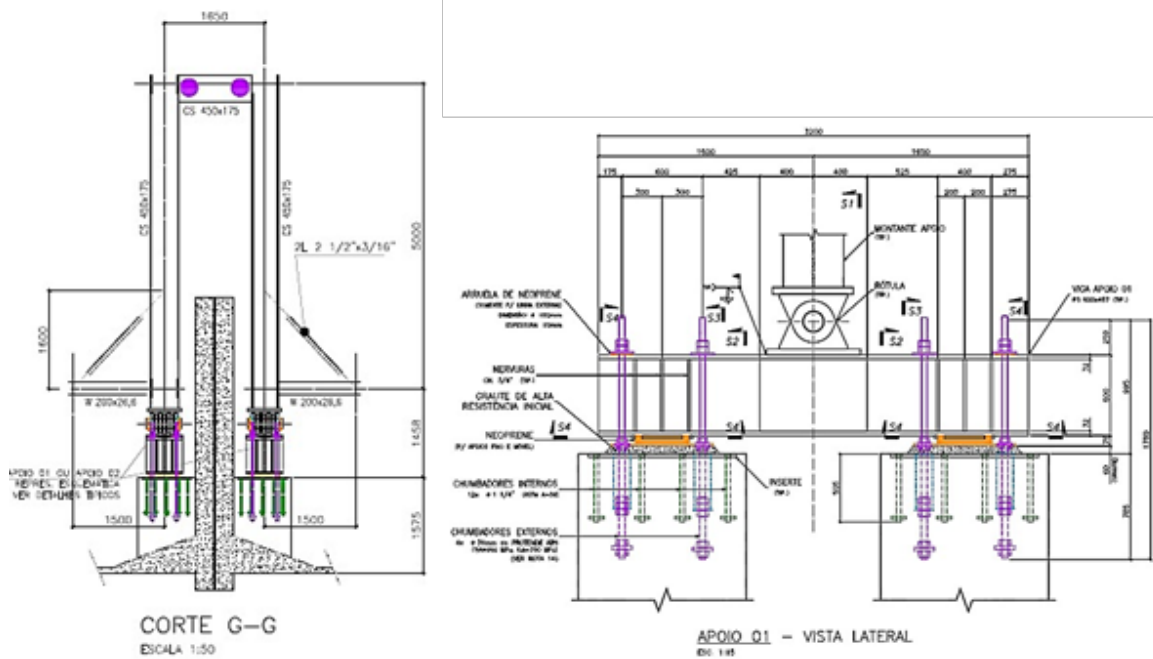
Ligações Metálicas da Treliça com Pilares de Concreto.
